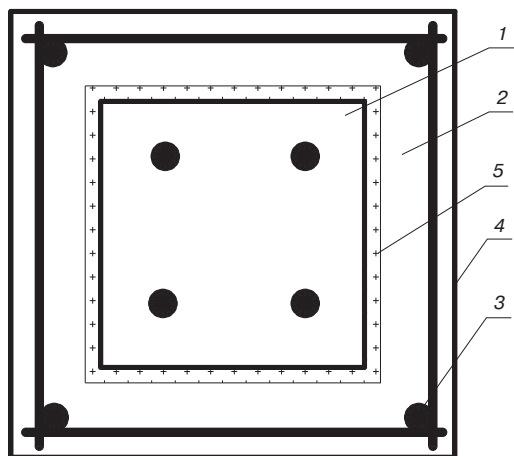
Наружная усиливающая конструкция колонн: 1 – усиливаемая колонна; 2 – железобетонная обойма; 3 – продольная арматура обоймы; 4 – поперечная арматура обоймы; 5 – слой адгезионной обмазки или прослойка из раствора на расширяющемся цементе
